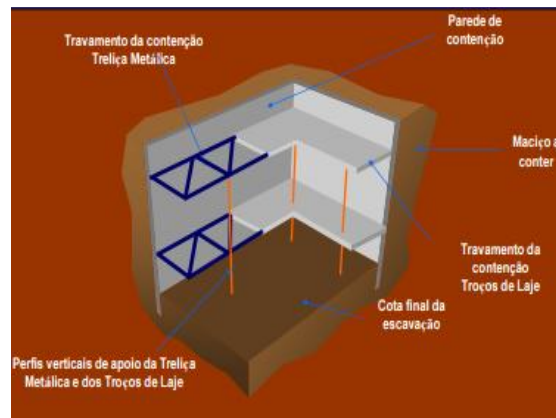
Exemplo de uso de bandas de laje, (Pinto, et al., 2008).
